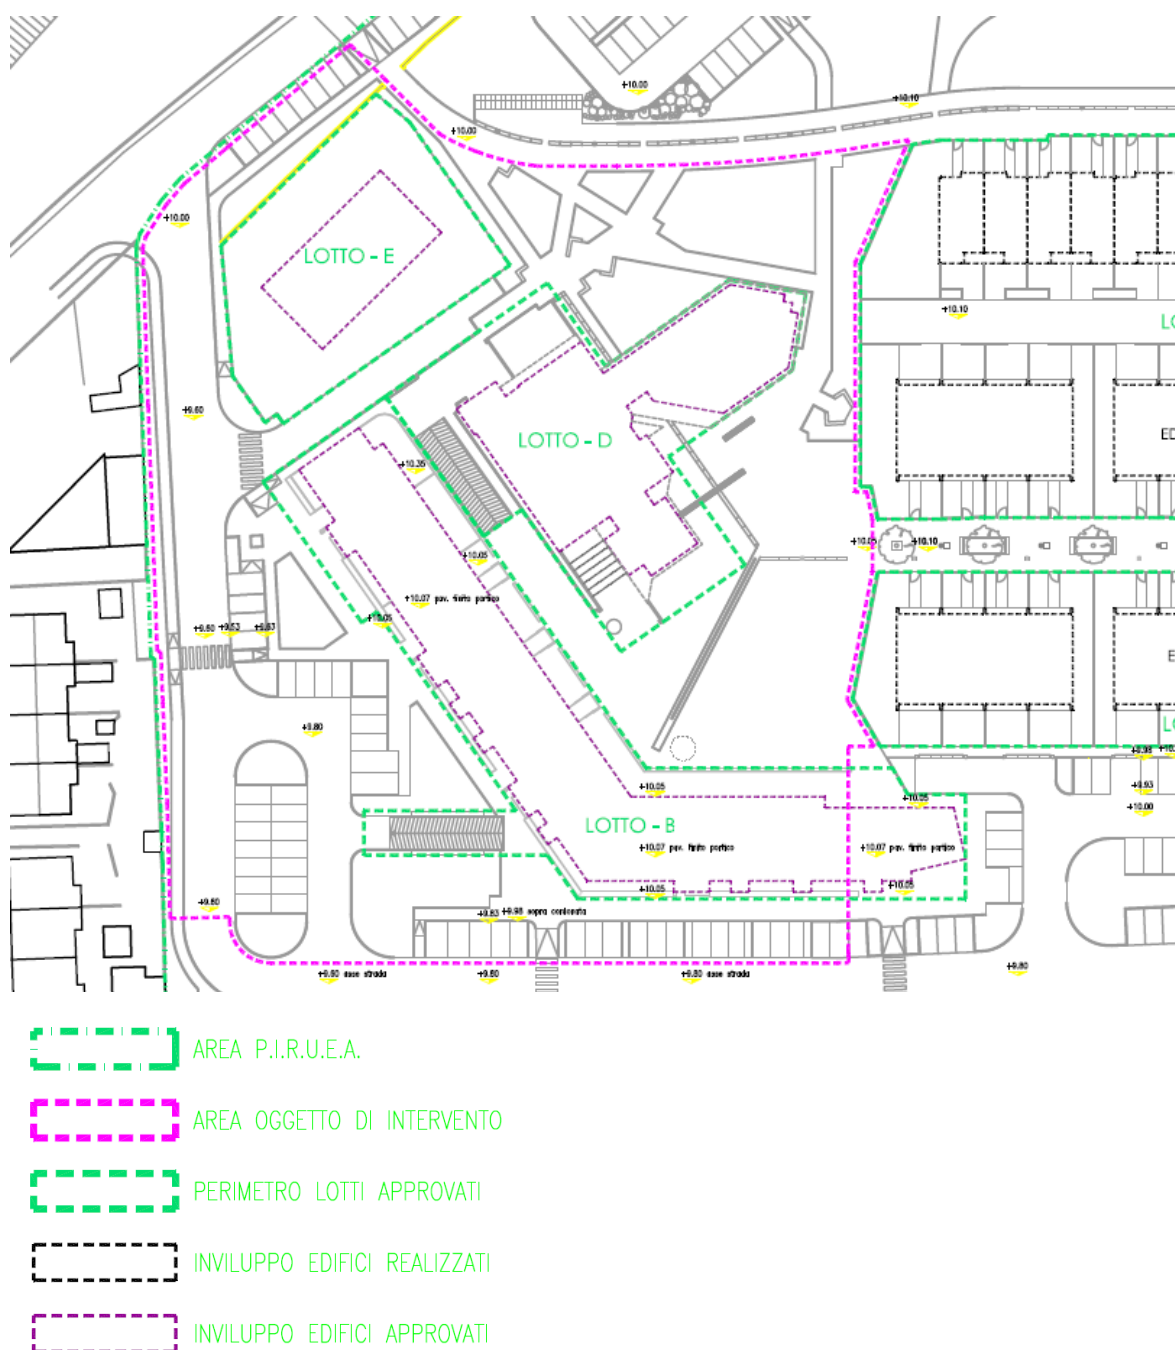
Tavola di progetto n. 2 - Stato di fatto (ambito indicato dal tratteggio viola).
